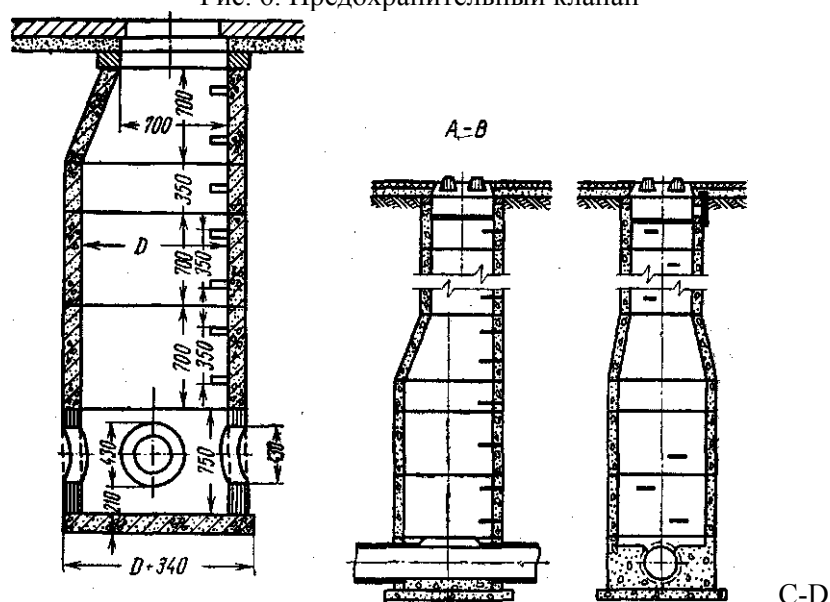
Сборный железобетонный колодец Рис. 8. Крупный колодец из бетонных колец
